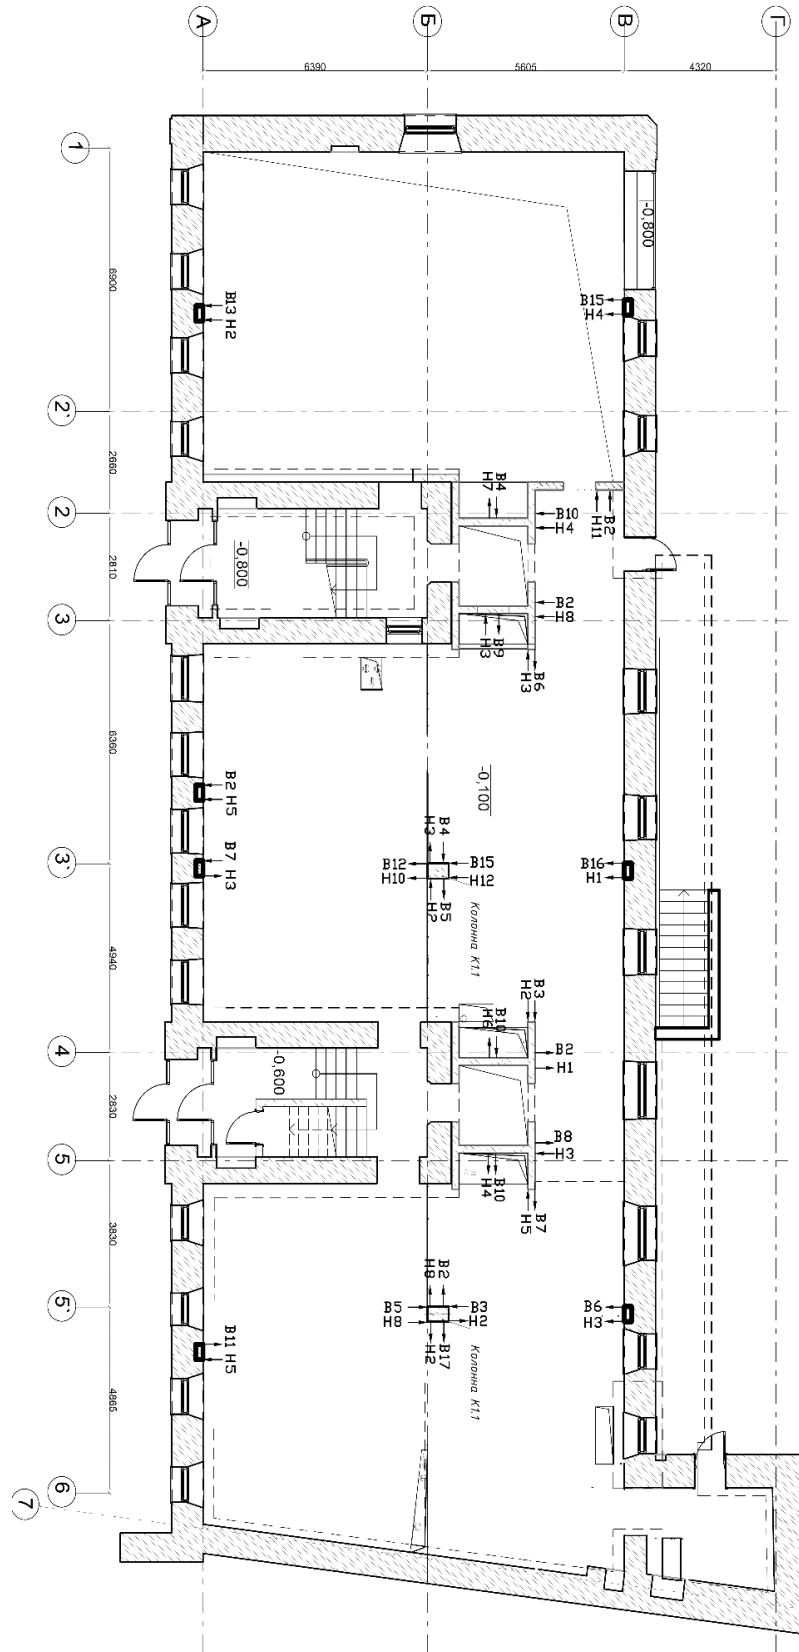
Фрагмент геодезической съемки 1-го этажа с отклонениями, в мм
